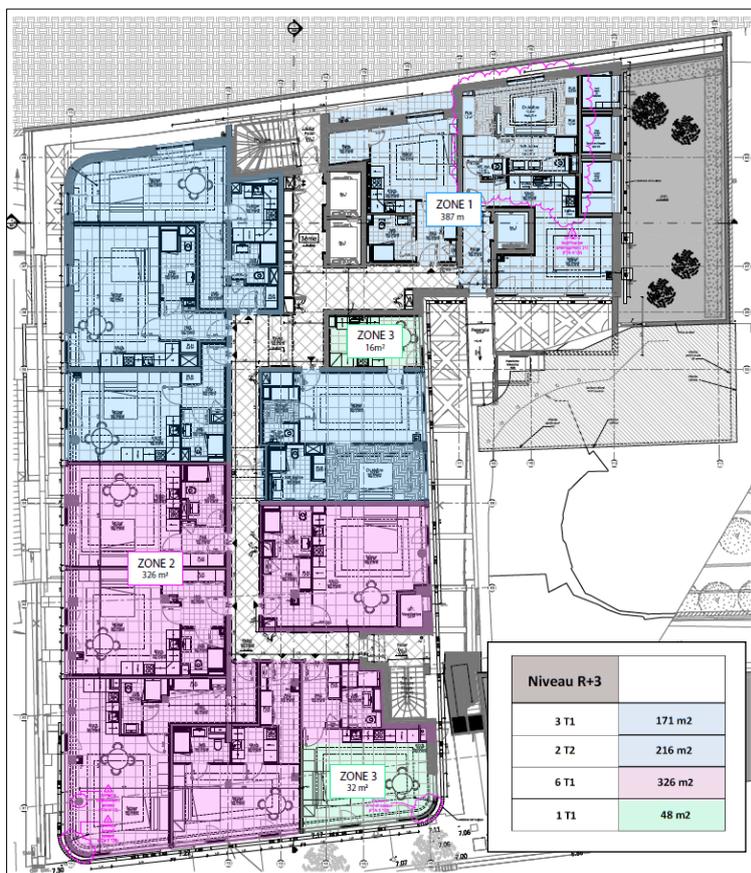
Divisione delle aree di lavoro del terzo piano (R+3)
